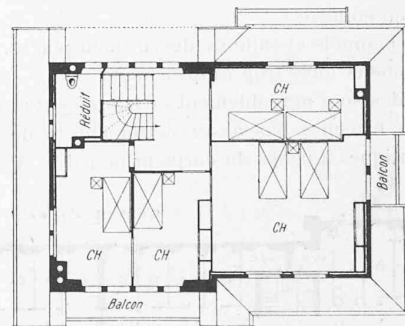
Plans d'une villa locative à Bellaria (La Tour-de-Peilz).
